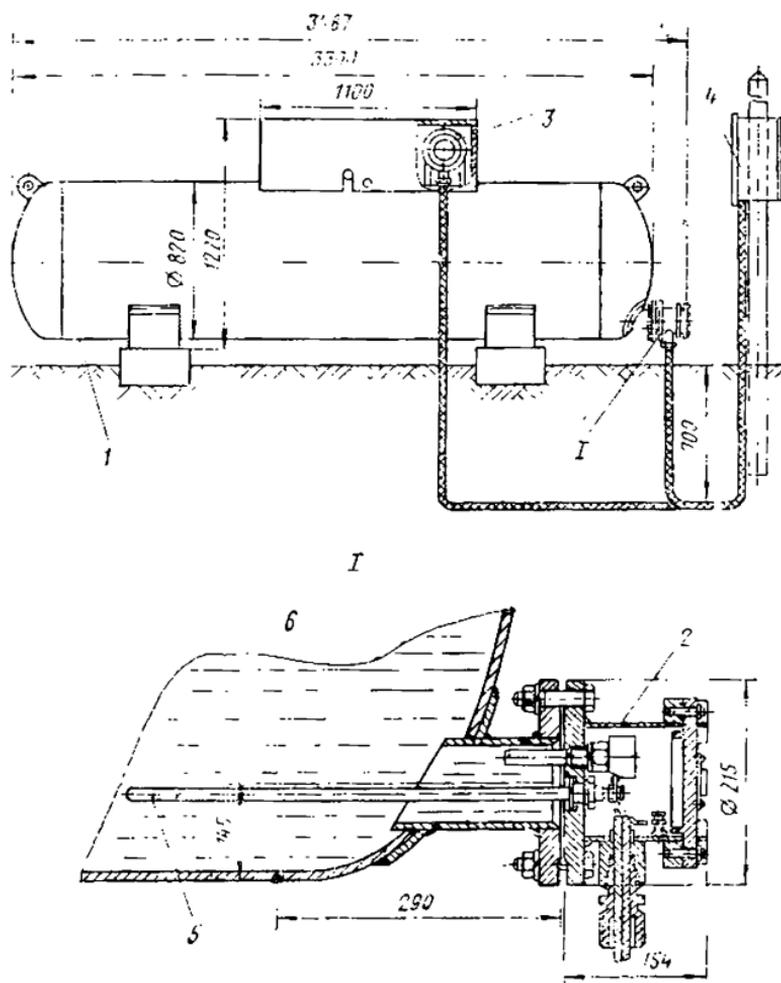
Съемный резервуар РС-1600 с регазификатором
